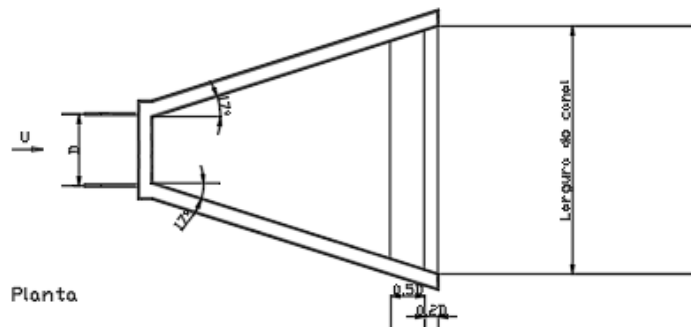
Planta de bacia de dissipação tipo PWD (adaptado de Pinheiro, 2006)
